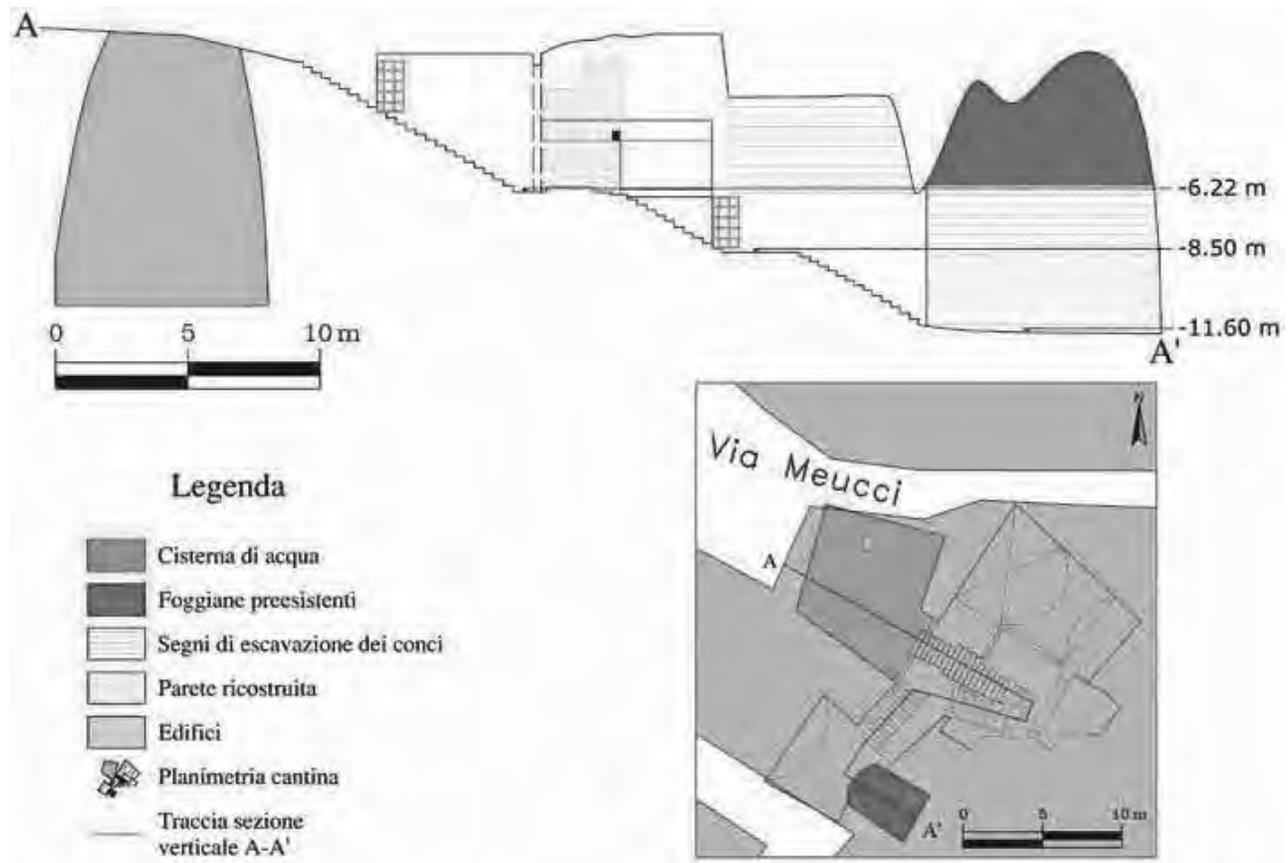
Planimetria e sezione verticale della cantina Cavallera (elaborazione grafica a cura degli Autori).
